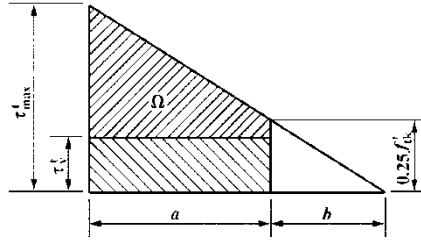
钢筋混凝土受弯构件剪应力图分配
